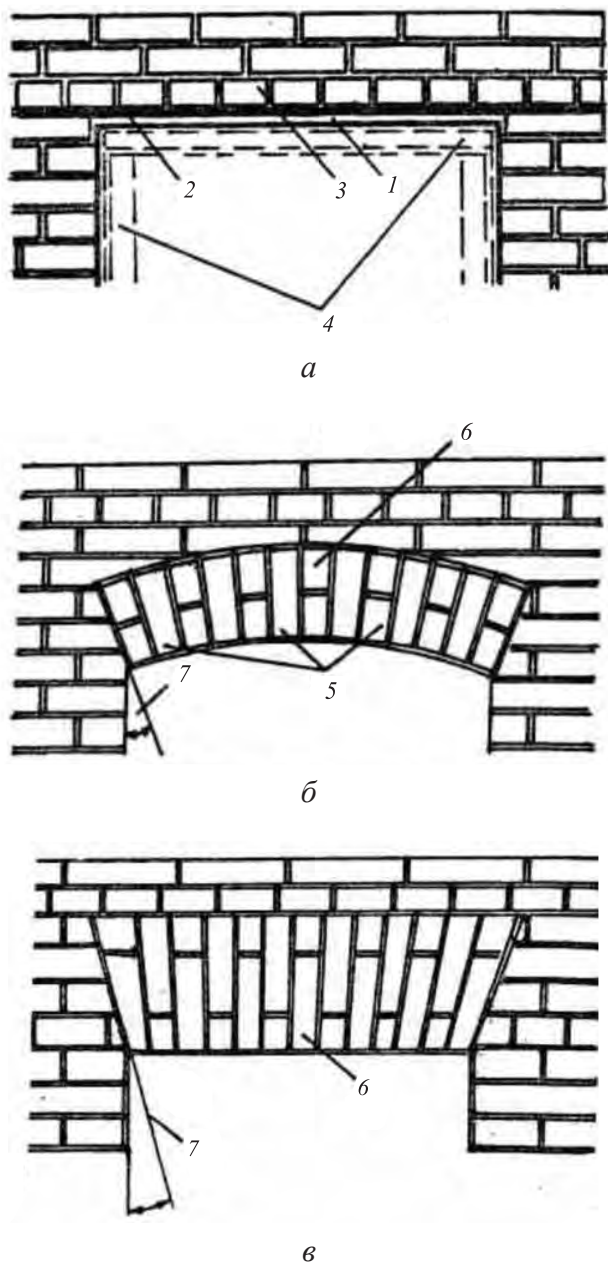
Перемычки из кирпичной кладки: *а* — рядовая; *б* — арочная; *в* — клинчатая: 1 — 4 см слоя раствора; 2 — арматура; 3 — кладка; 4 — опалубка; 5 — кладка арки; 6 — замковые кирпичи; 7 — угол кладки кирпичей
